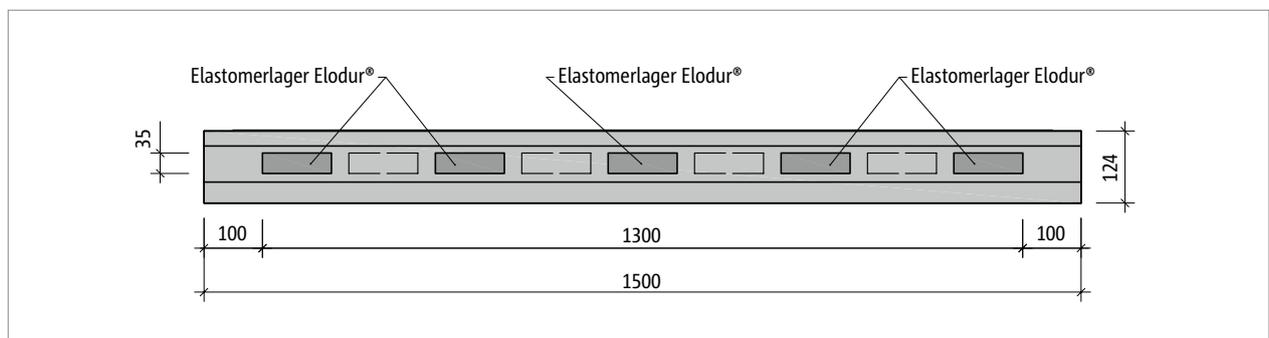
Schöck Tronsole® Typ F: Grundriss
